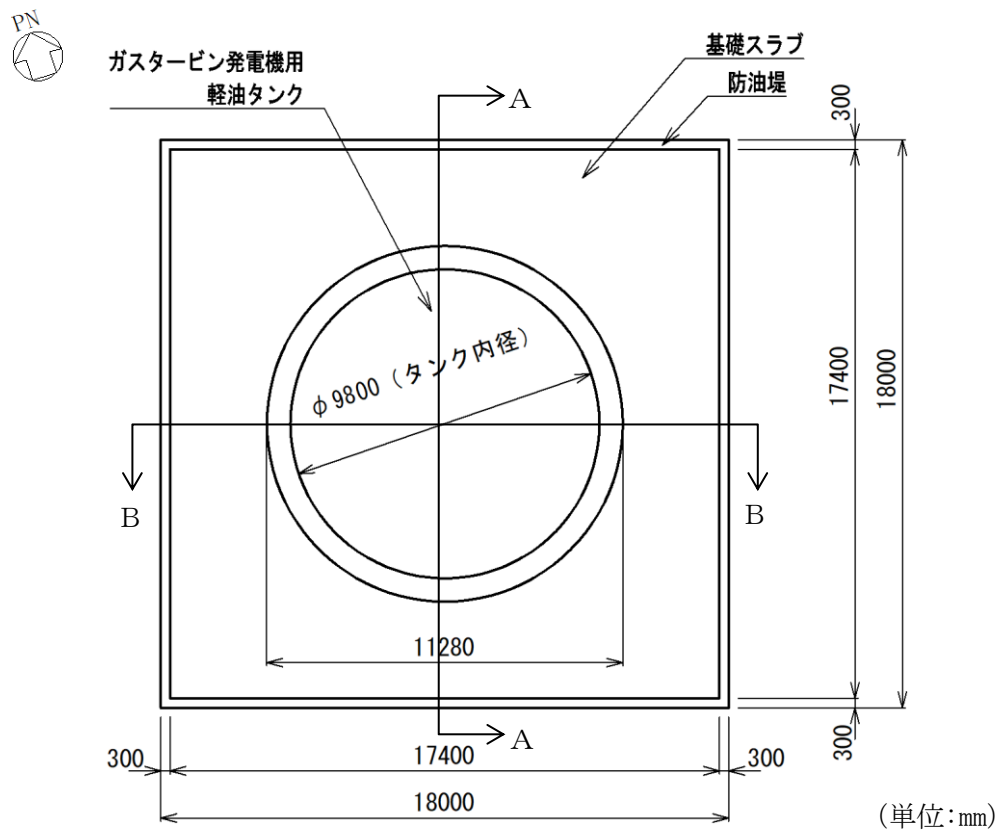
ガスタービン発電機用軽油タンク基礎 平面図
